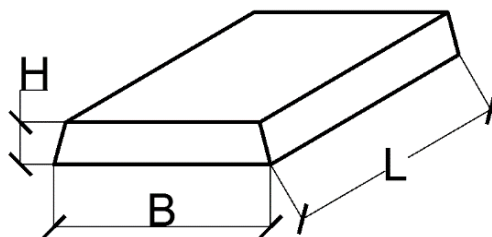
Плиты железобетонные ленточных фундаментов сплошные (тип 1)
